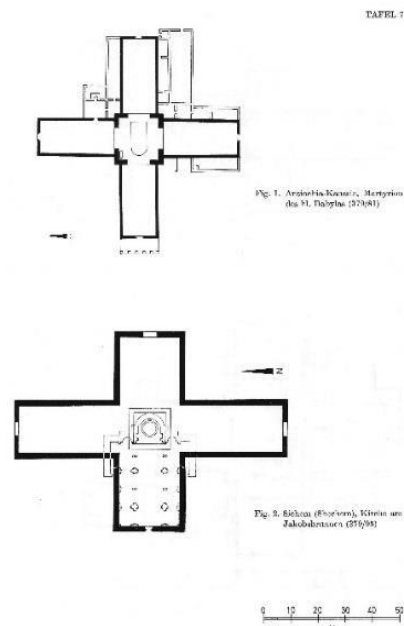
u. 129: Östliche Zentralbauten, Grundrisse
